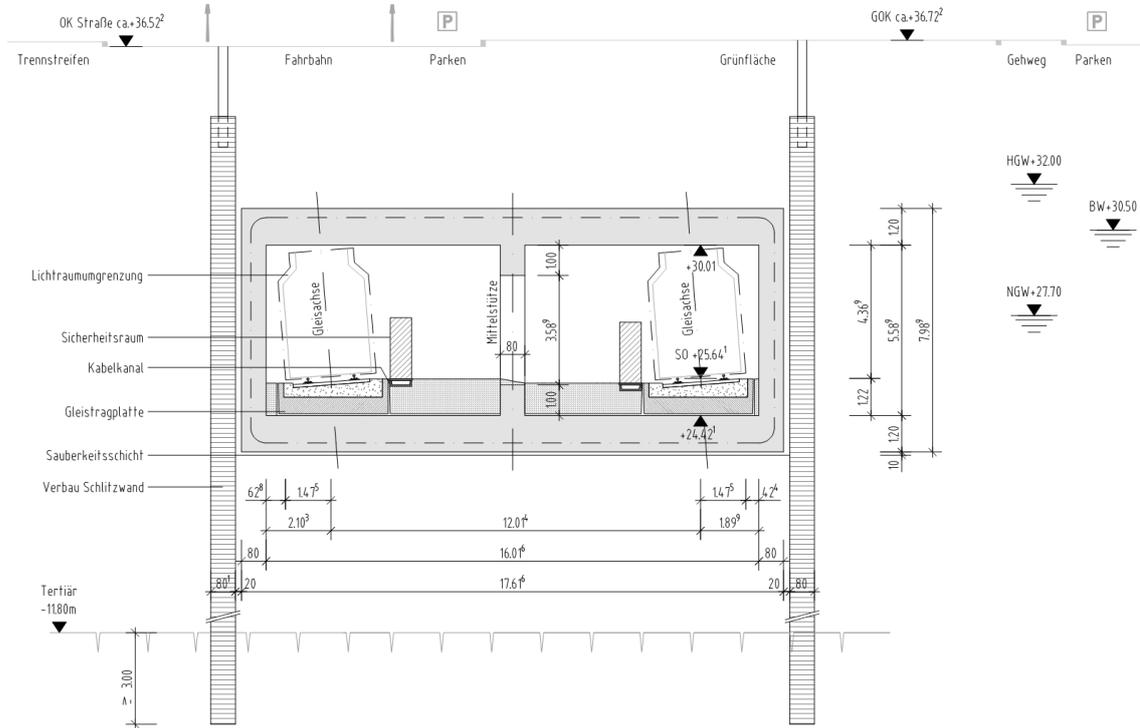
Ansicht – Beispiel für Tertiäreinbindung der Schlitzwände bei Baugrube „Tunnelstrecke“
